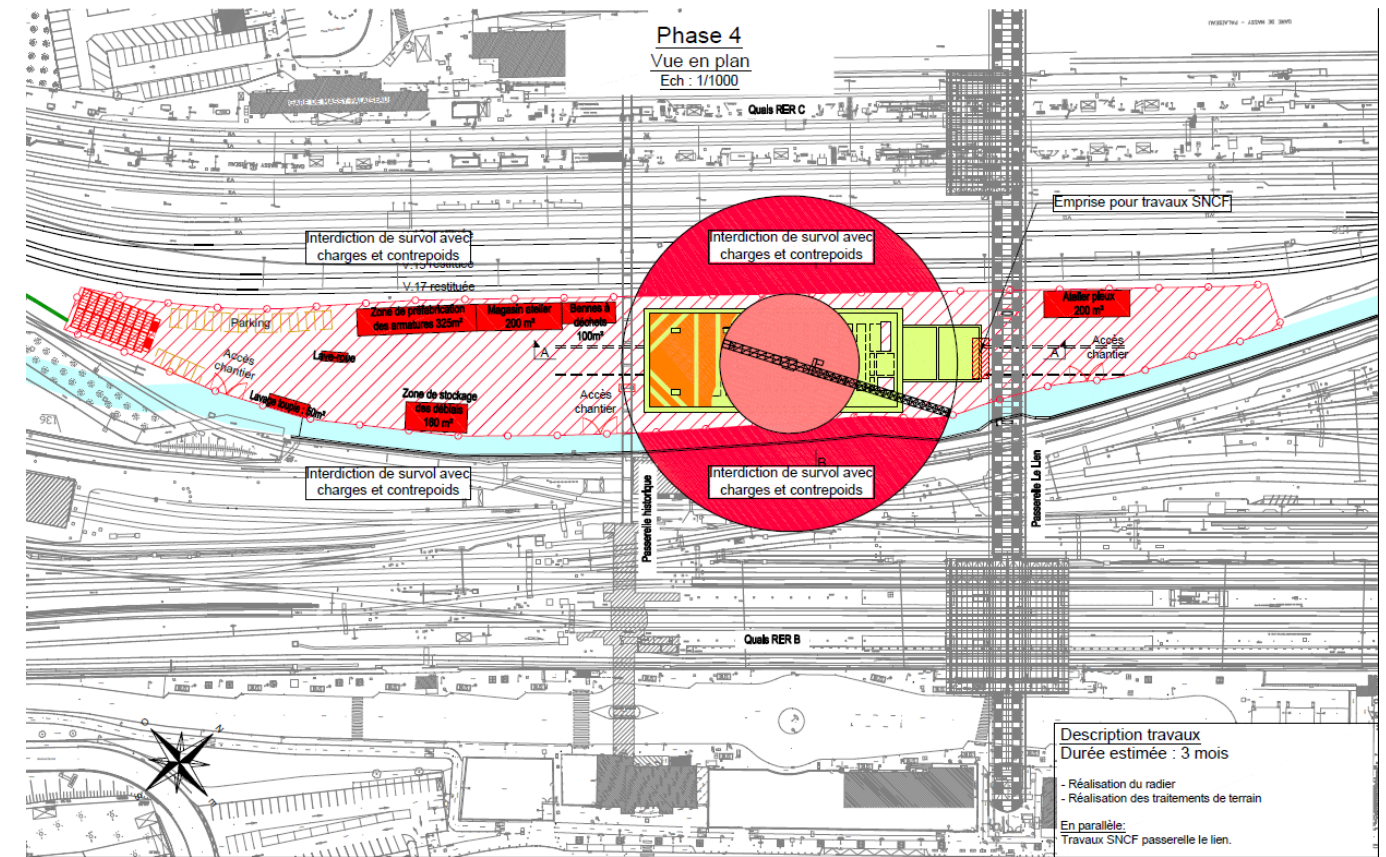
Étape n°4 des travaux-travaux de la superstructure
